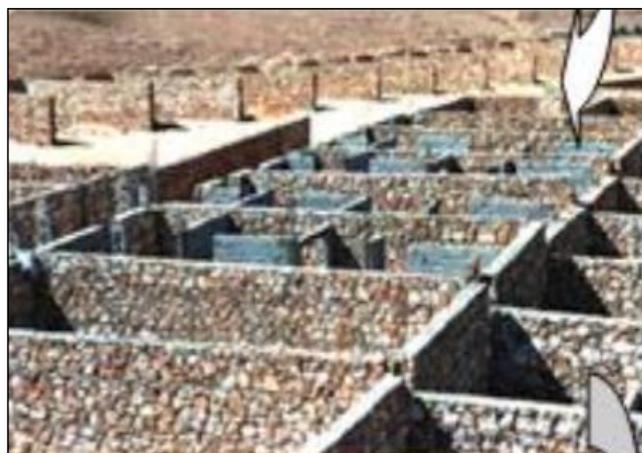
photo de chantier du ksar tafilalet. source: fondation amidoule.
